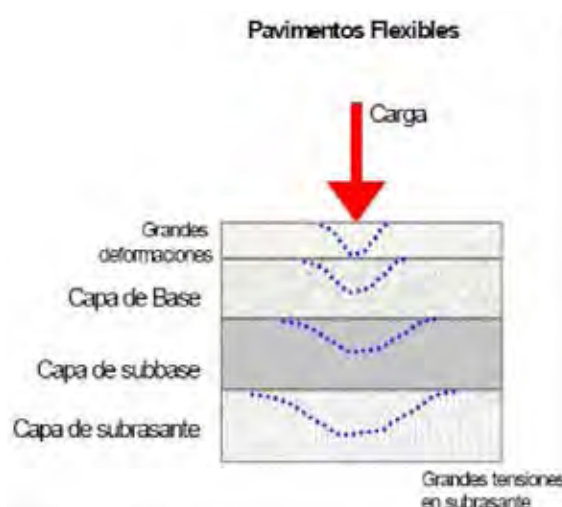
Tensiones en las diferentes capas de un pavimento flexibles.
